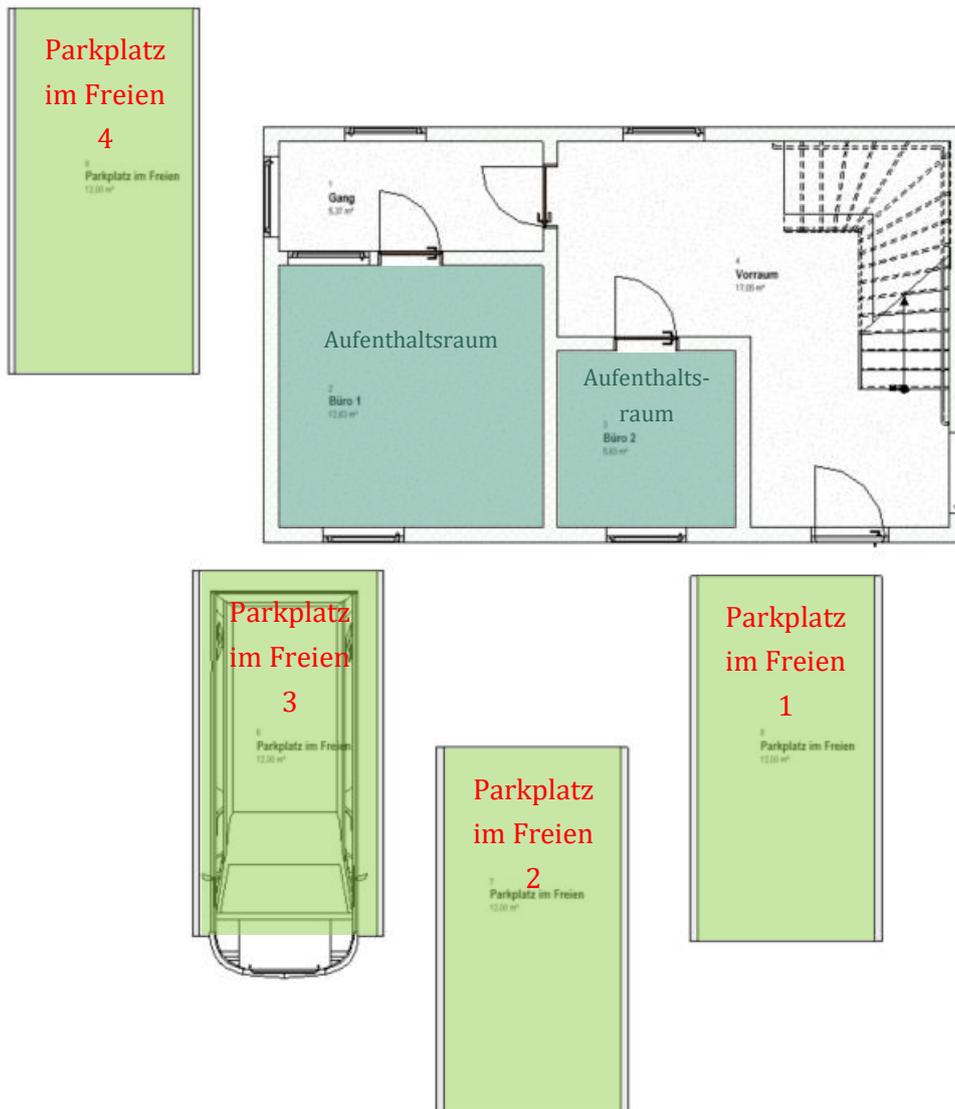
Grundriss BIM-Modell WGarG §6 Abs 2
